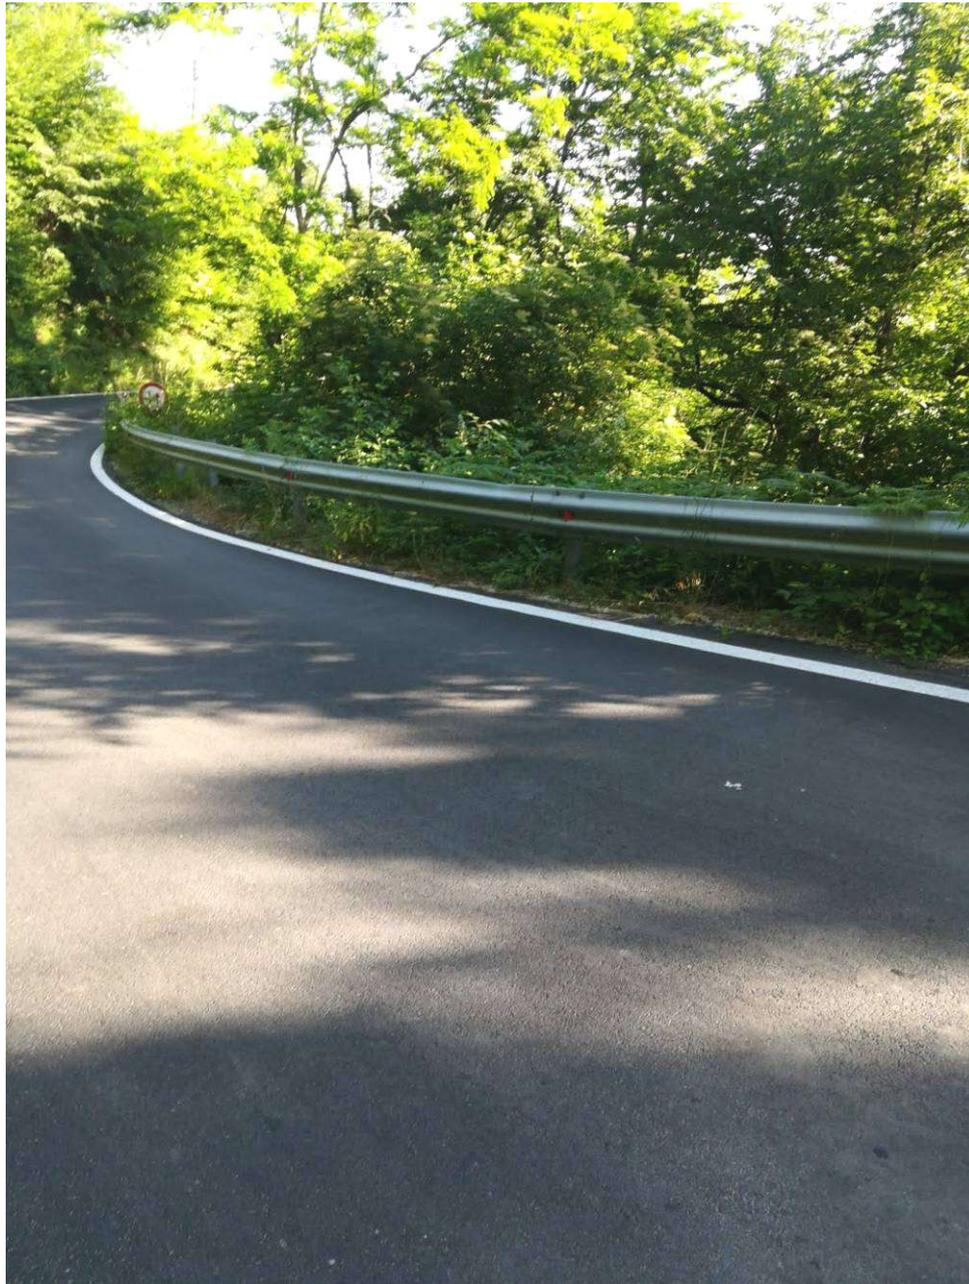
Vista da monte del tratto di strada su cui insiste il manufatto dell'intervento di valle.
